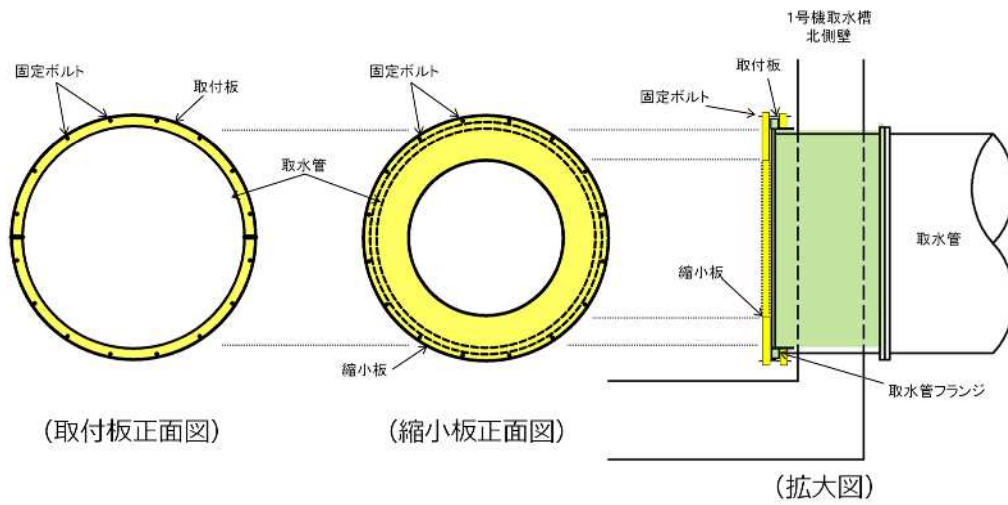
1号機取水槽流路縮小工の平面配置図
